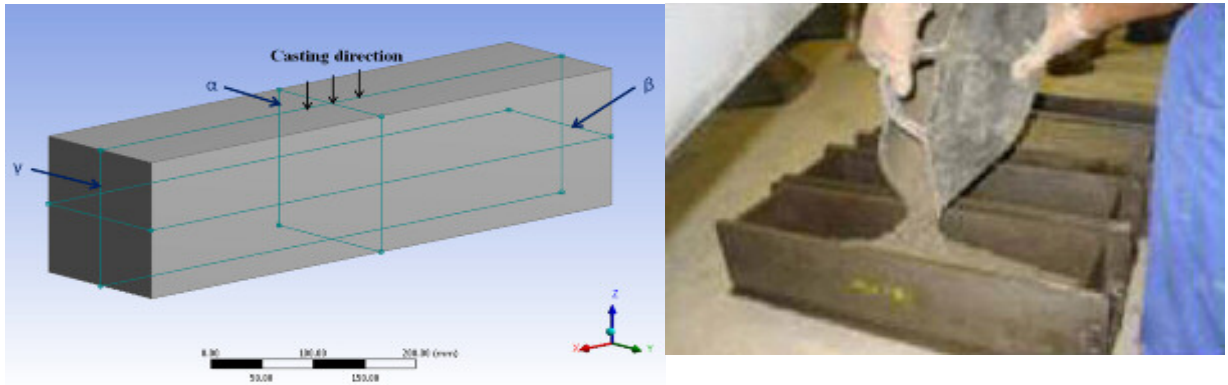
参考文献<sup>1)</sup>の実験に対する解析モデル
